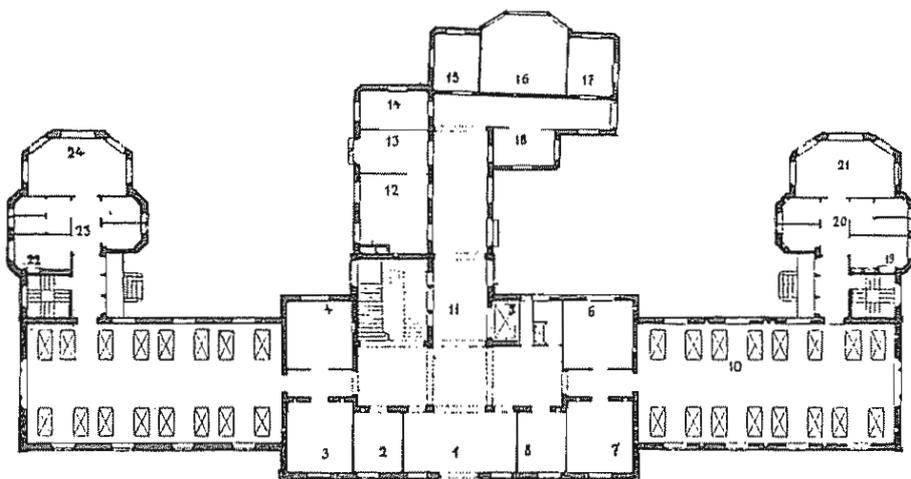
PADIGLIONE CHIRURGICO ZONDA - PIANTA DEL PIANO TERRENO
